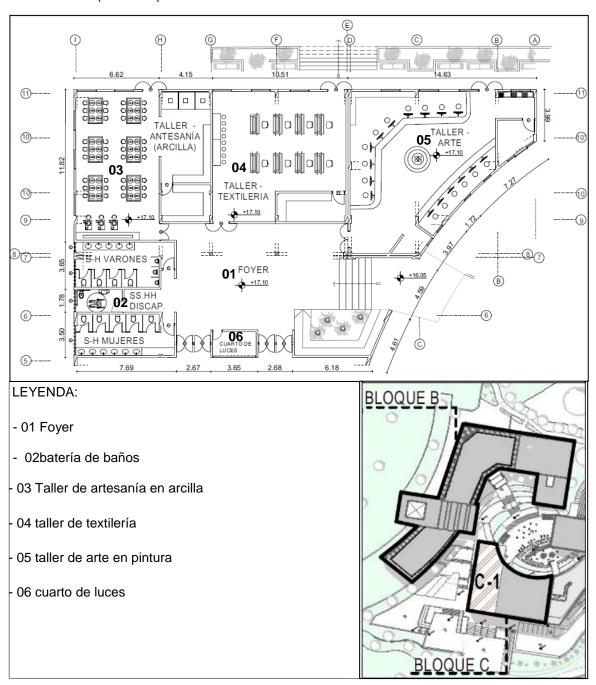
6 Planteamiento del plano de planta general de arquitectura de la zona de aplicación
